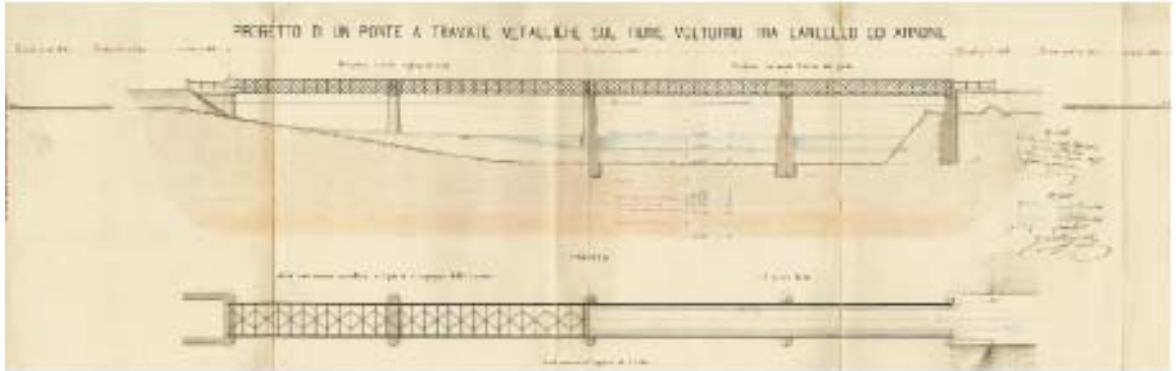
Ponte a travate metalliche su pilastri in muratura, pianta e prospetto, Cancello Arnone, ing. Dura; ASce, Amministrazione Provinciale, f. 11638, anno 1876
